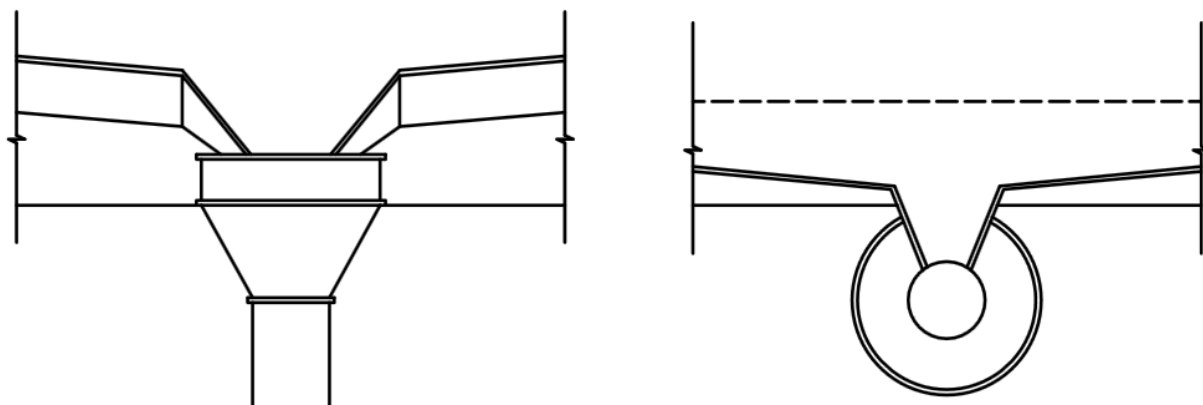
Схема присоединения воронки к кровле здания
